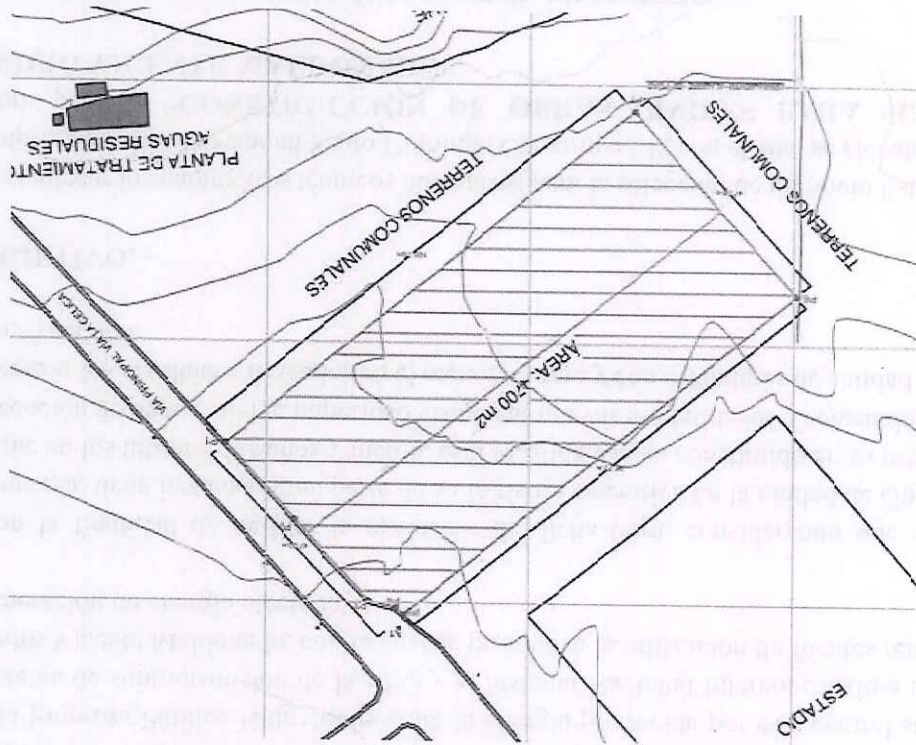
Levantamiento Topográfico Subestación Pedro Vicente Maldonado
